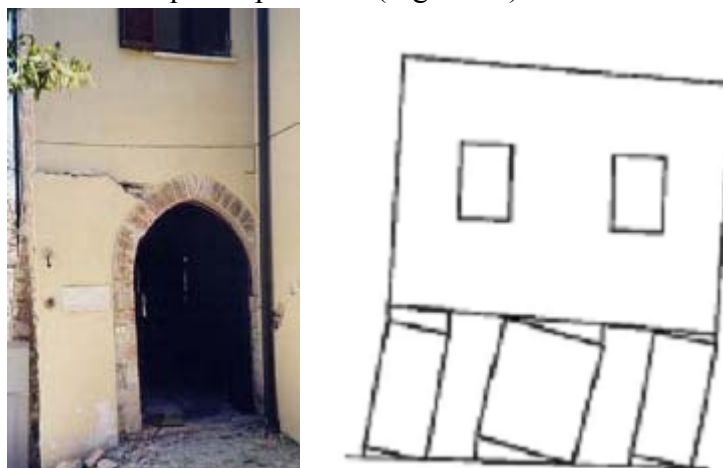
Cedarea în plan a pereților portanți [2]
